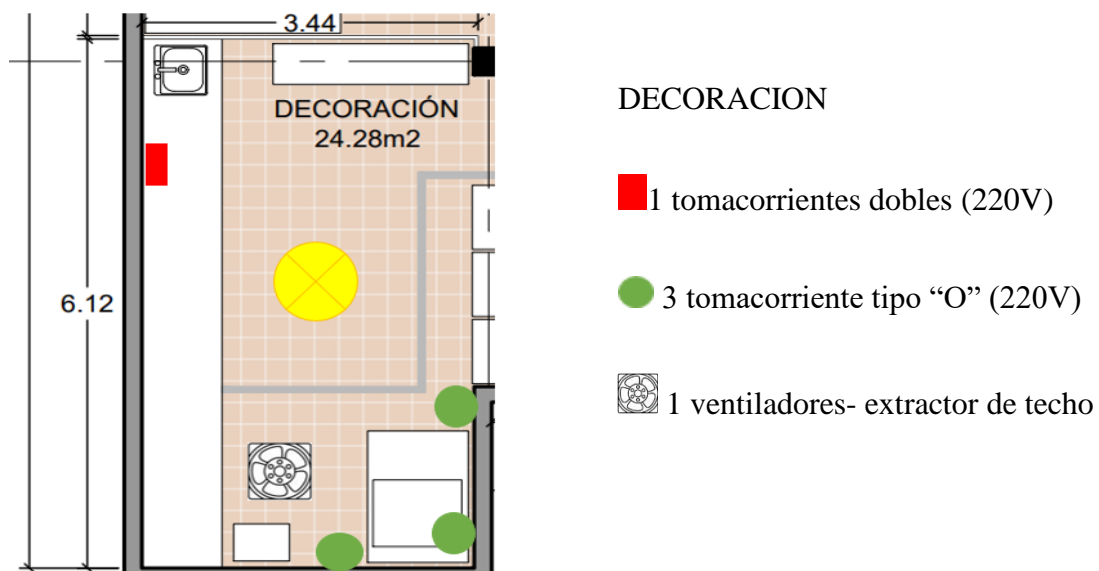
Plano eléctrico - decoración, fuente: autores
